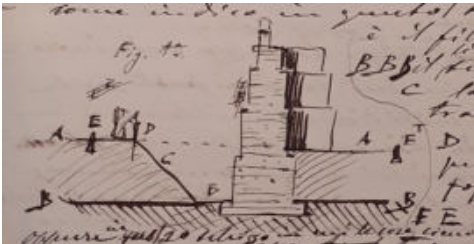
Schizzo con individuazione dei livelli del terreno storico e contemporaneo (ASTO, Fondo D'Andrade, busta 67, 12 novembre 1889)
